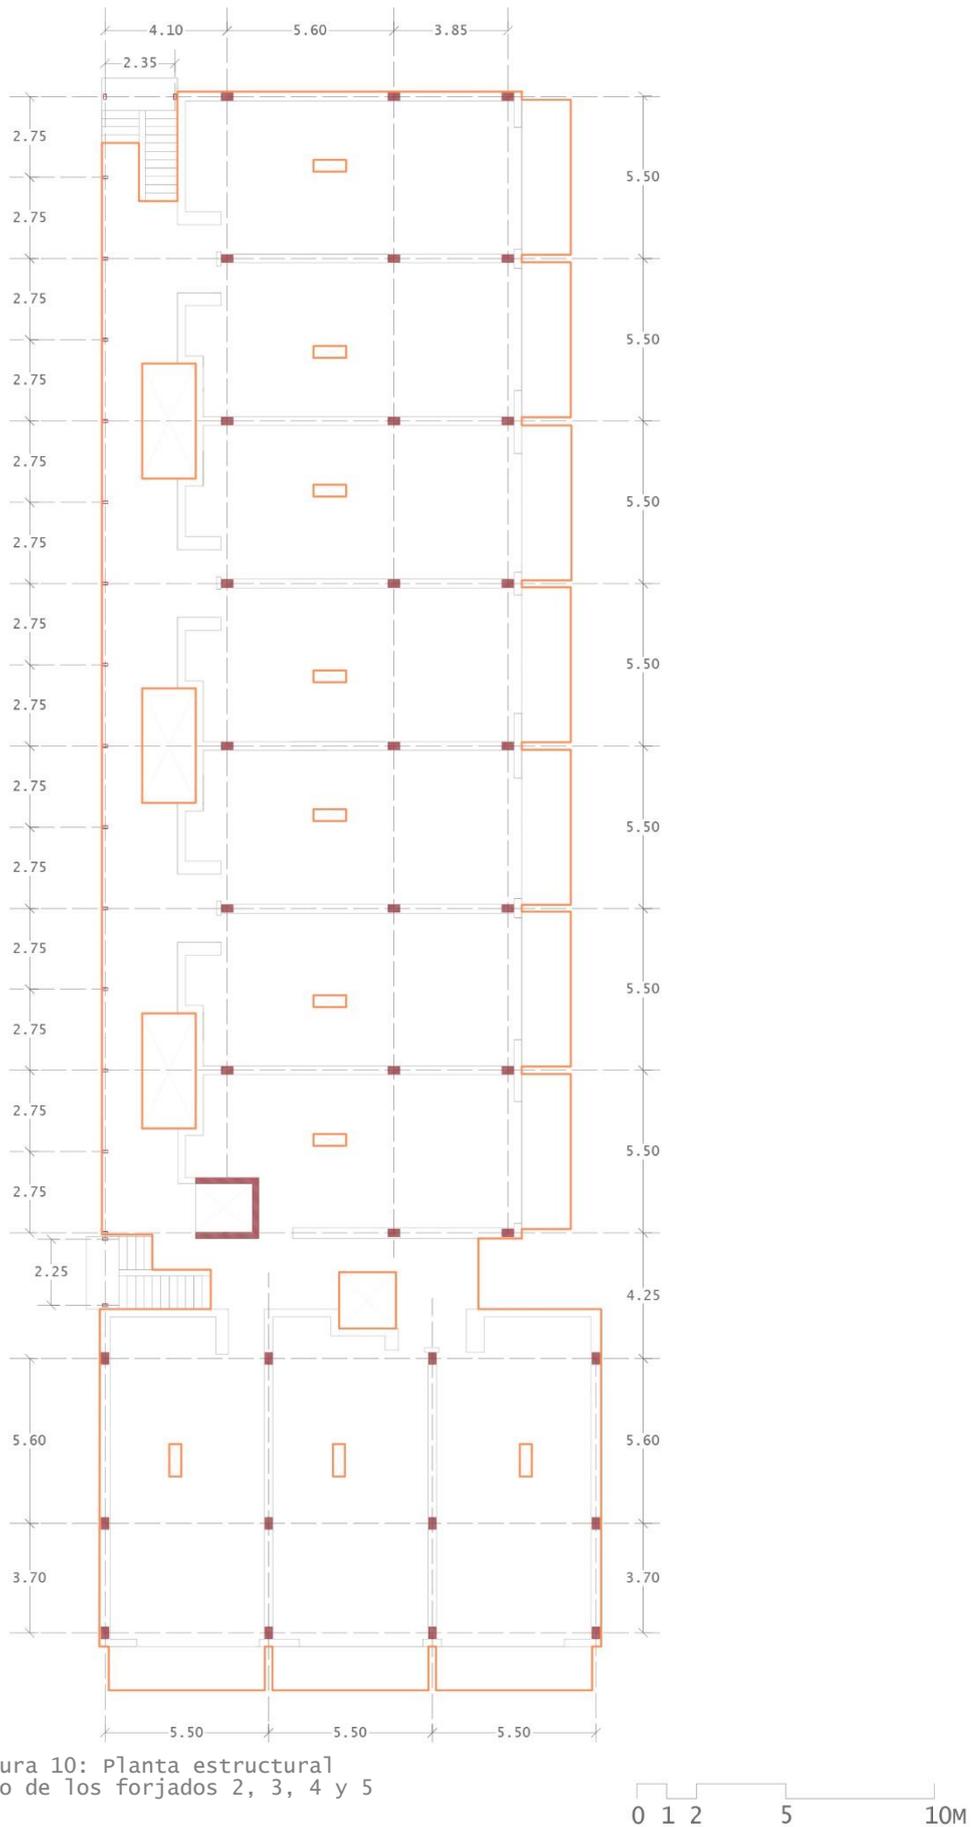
Planta estructural tipo de los forjados 2, 3, 4 y 5
